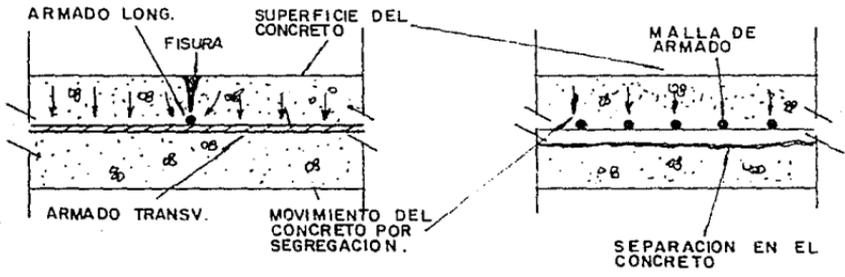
FISURAS EN EL CONCRETO A CAUSA DE LA SEGREGACION.
